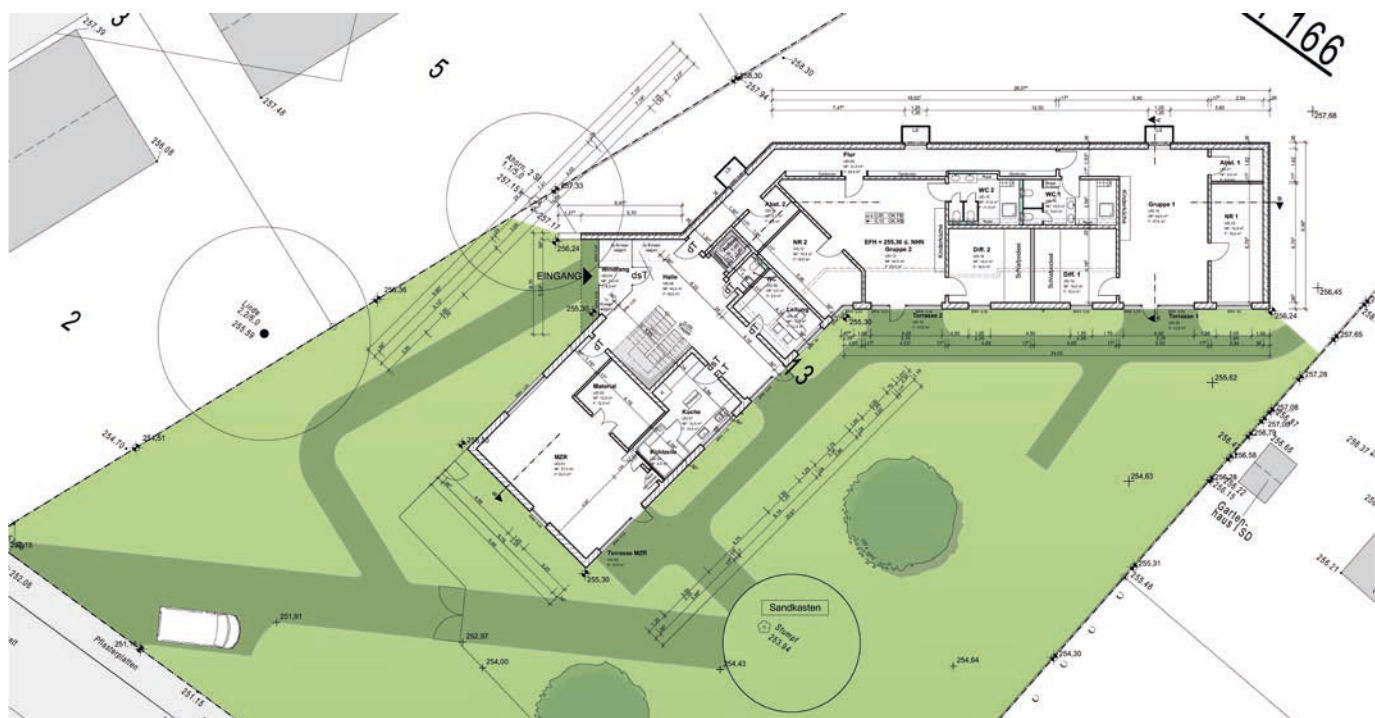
Grundriss und Freiflächenplanung des vierzügigen Kindergartens der Stadt Remscheid (Planungsstand 24.11.2016)
